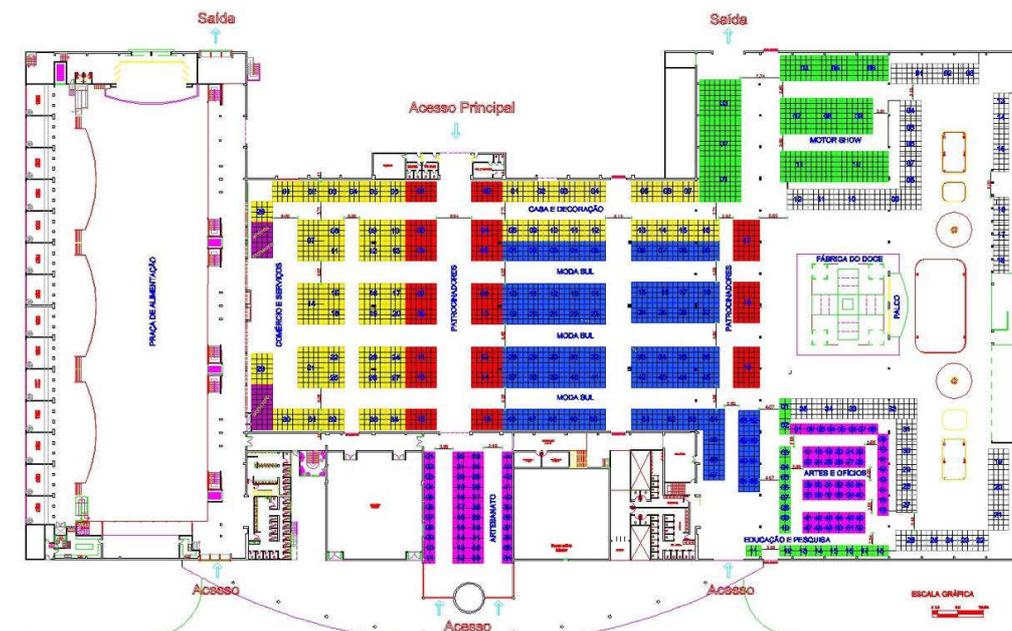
Planta Baixa do Pavilhão da Fenadoce (Fenadoce, 2009)
